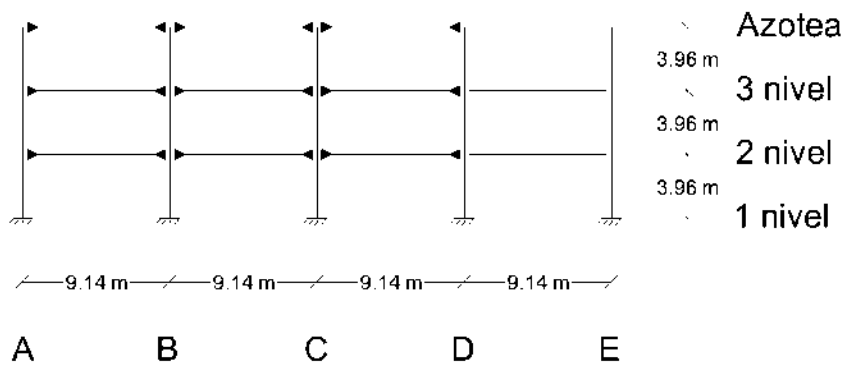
Vista en elevación del edificio de 3 niveles.
